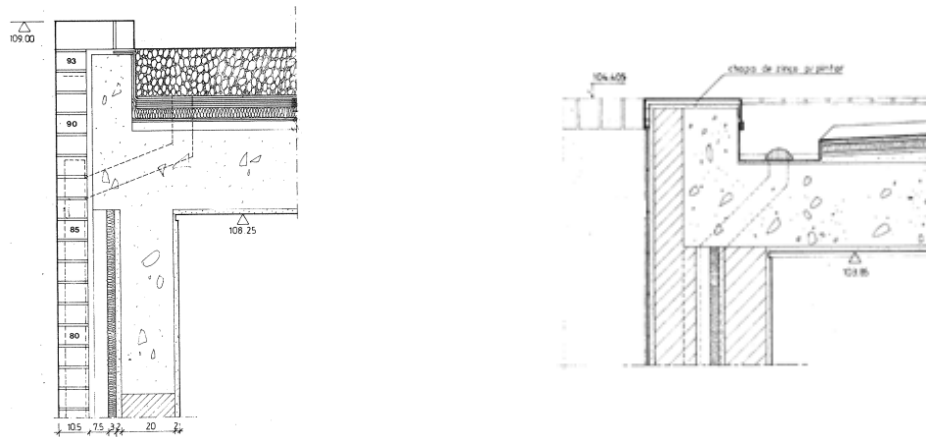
Pormenores construtivos do pano de alvenaria, junto às platibandas
